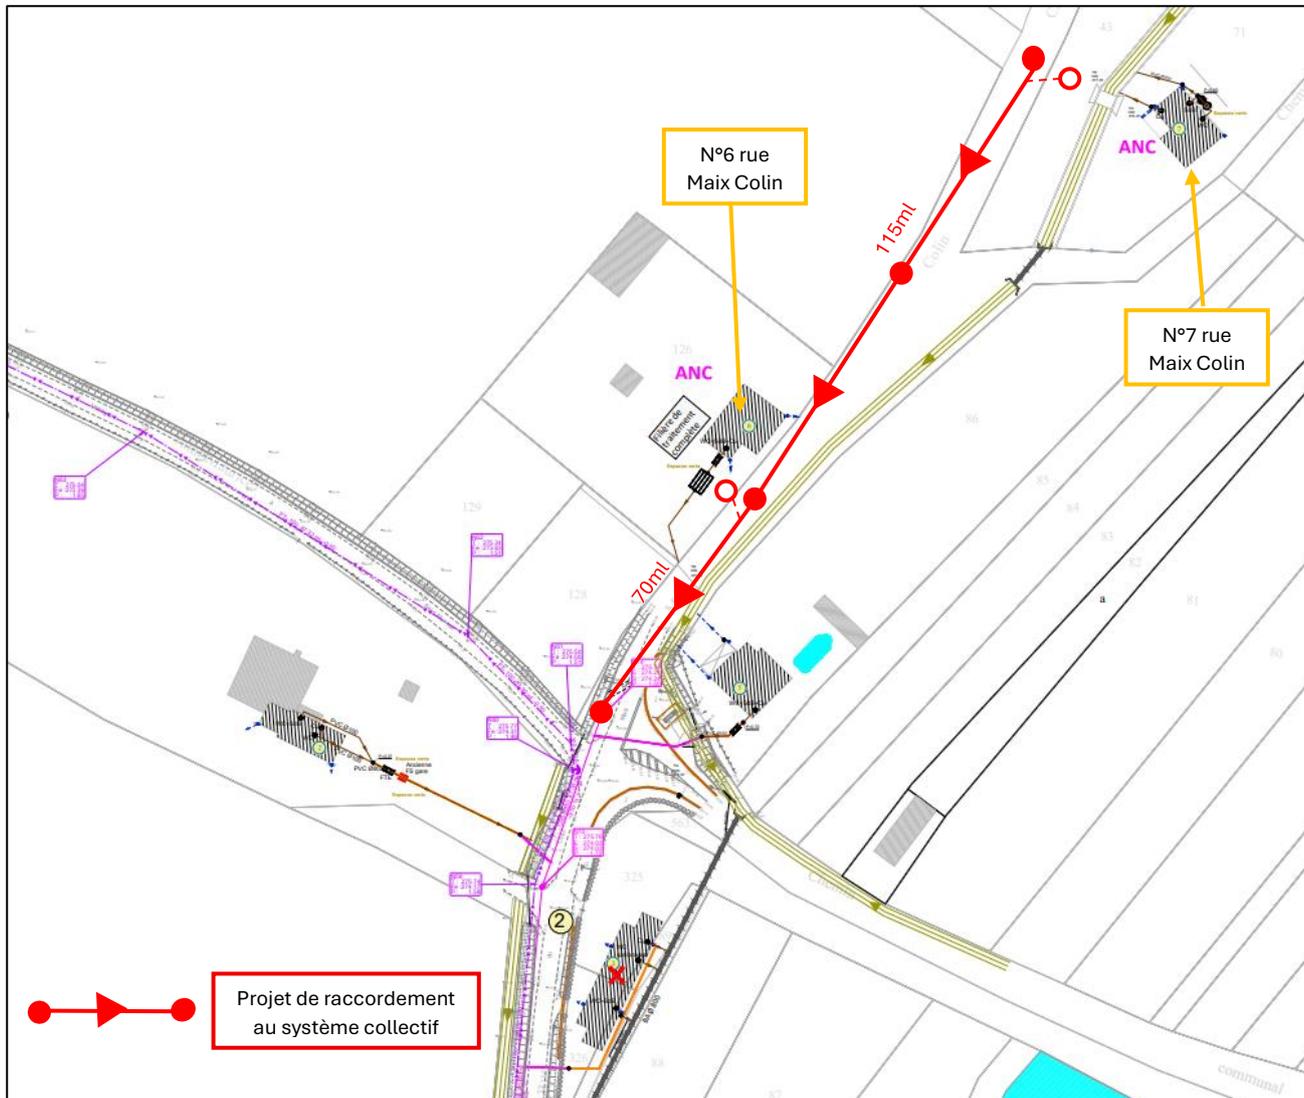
Plan de principe du raccordement des habitations N°6 et N7 rue Maix Colin au système d’assainissement collectif
